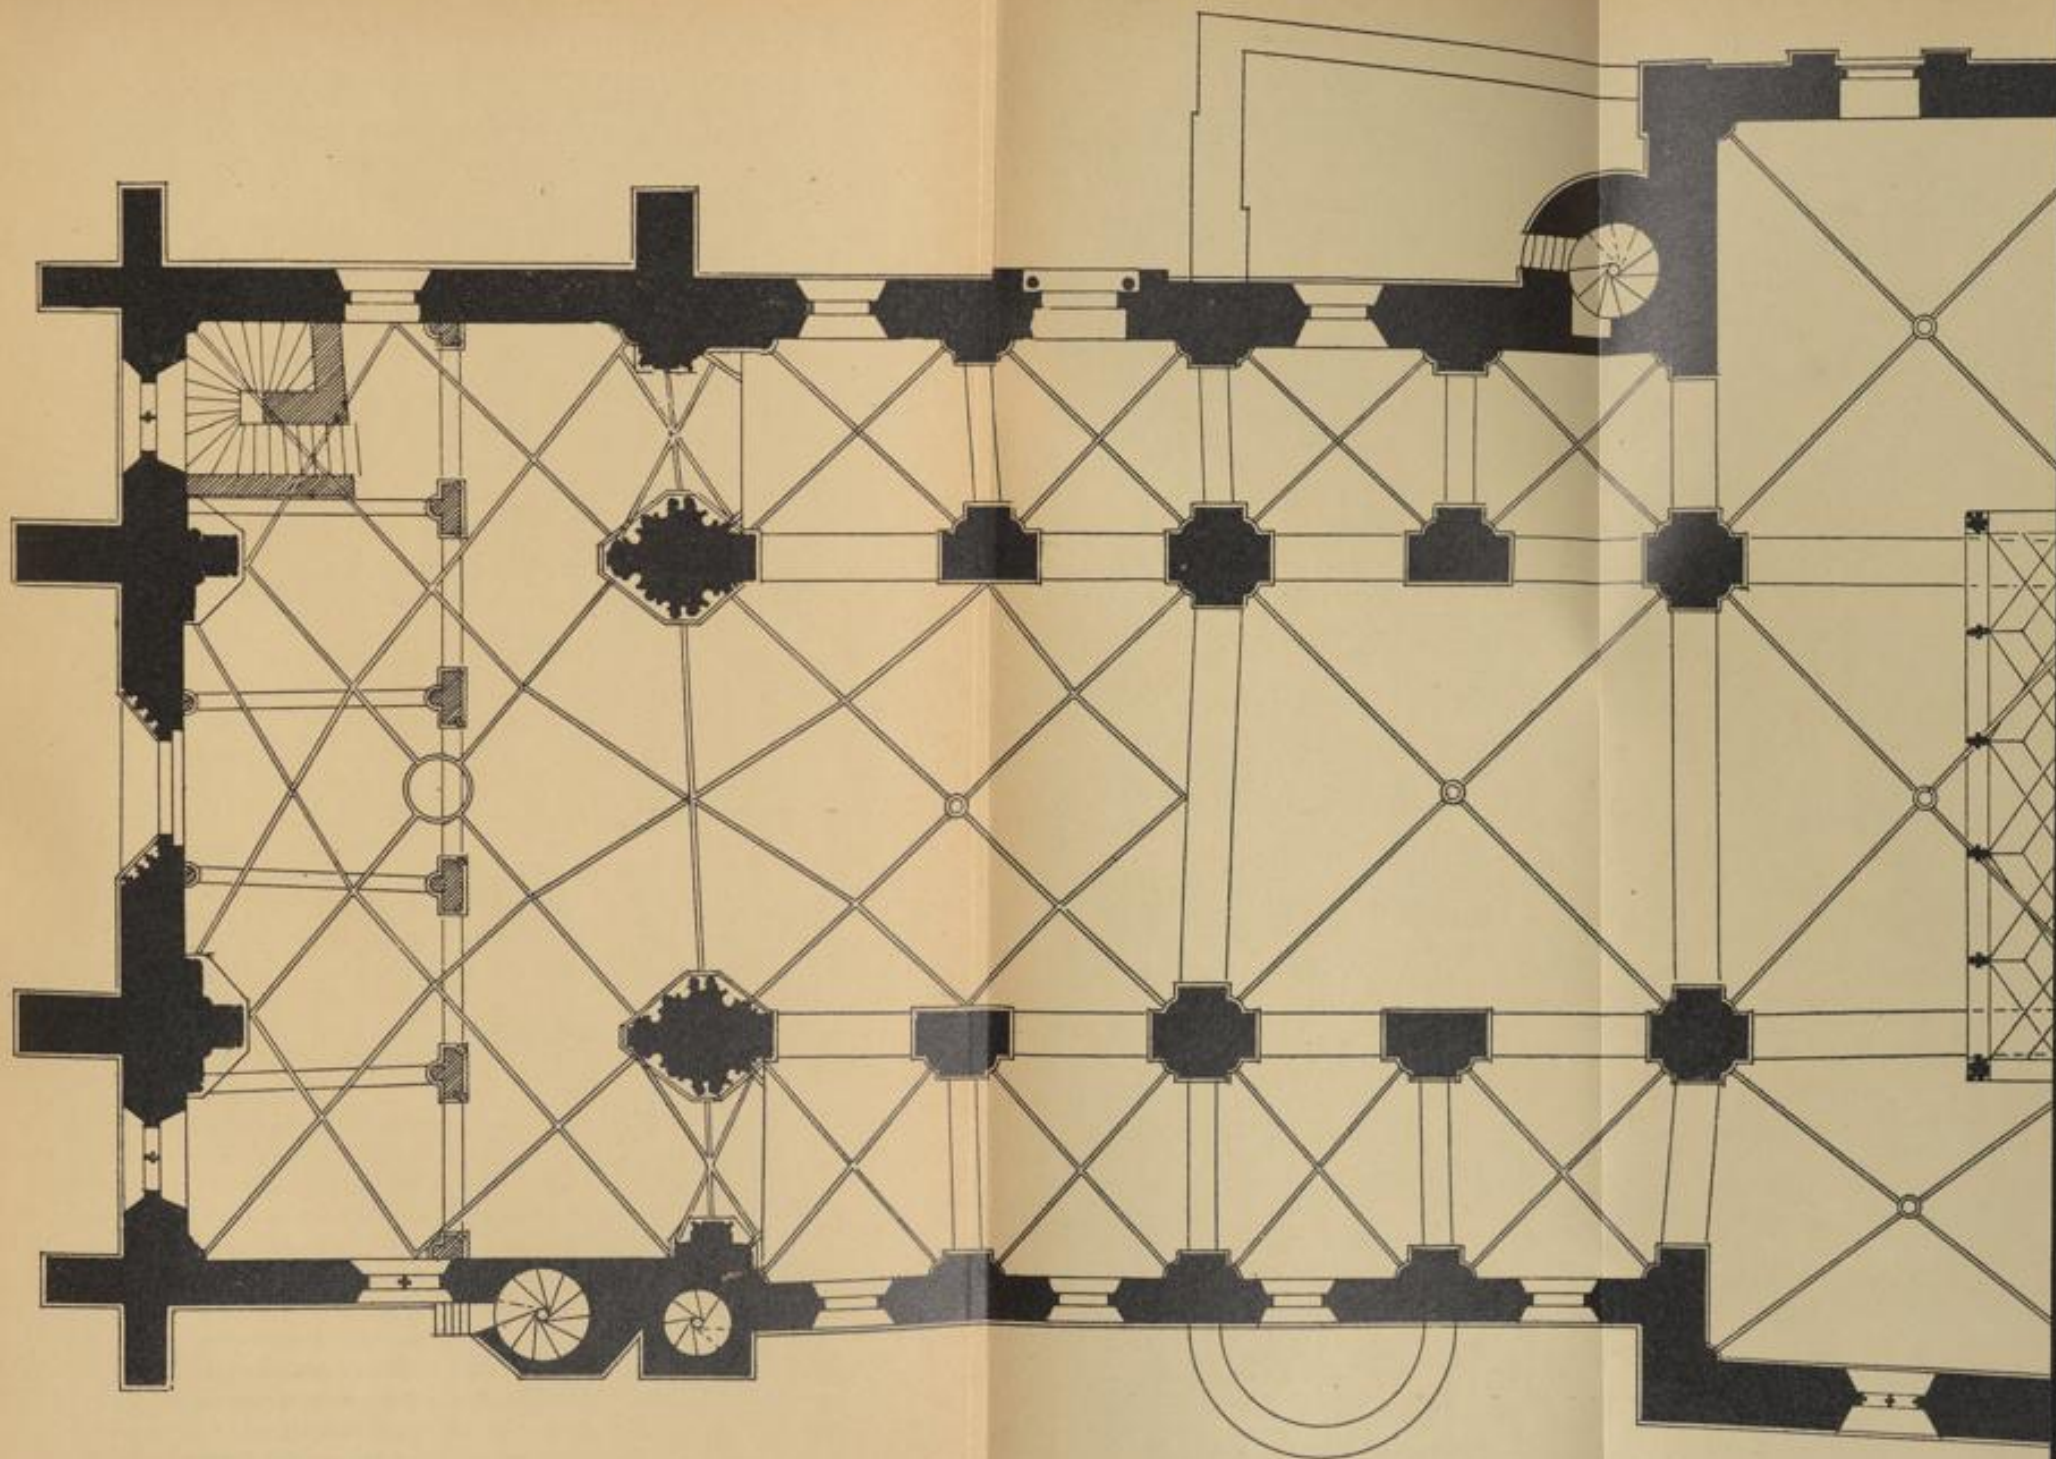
Breisach. Grundriss des Münsters.
